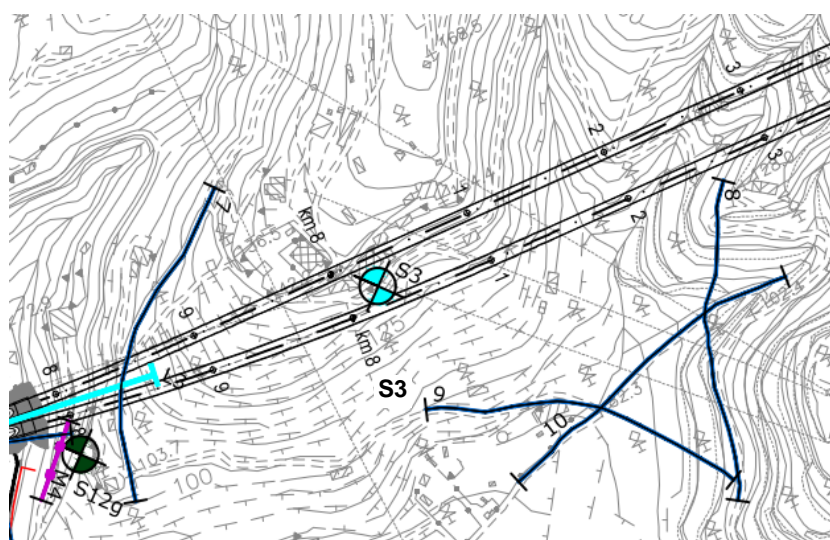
Planimetria con ubicazione del sondaggio S3.
